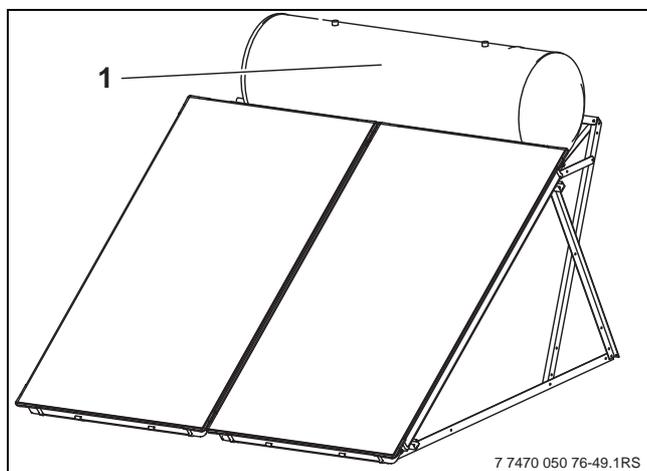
Vista da instalação em telhados planos (aqui, sistema de 300 l)
